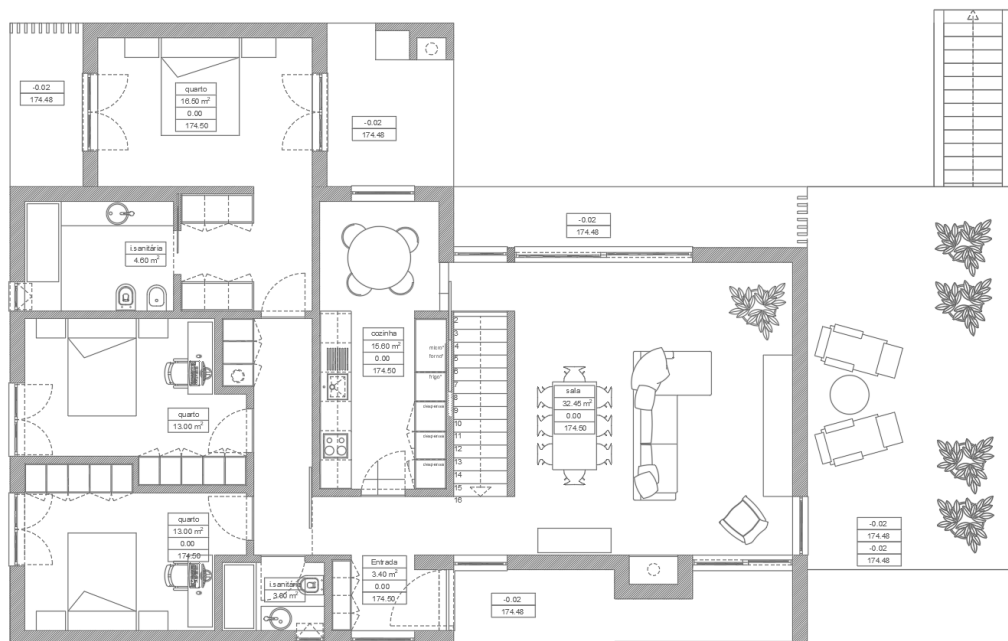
Piso elevado (Projeto de arquitetura).
